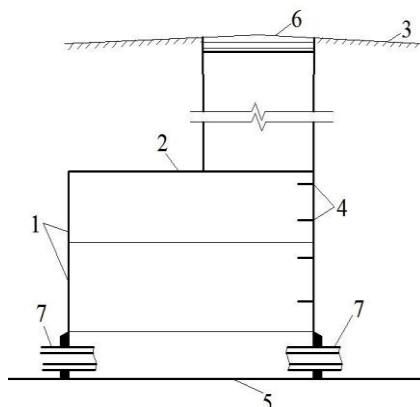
Схема устройства водопроводного колодца: 1 – кольца; 2 – плита перекрытия; 3 – каменная отмостка; 4 – ходовые скобы; 5 – плита дна; 6 – чугунный люк с крышкой; 7 – трубопроводы
